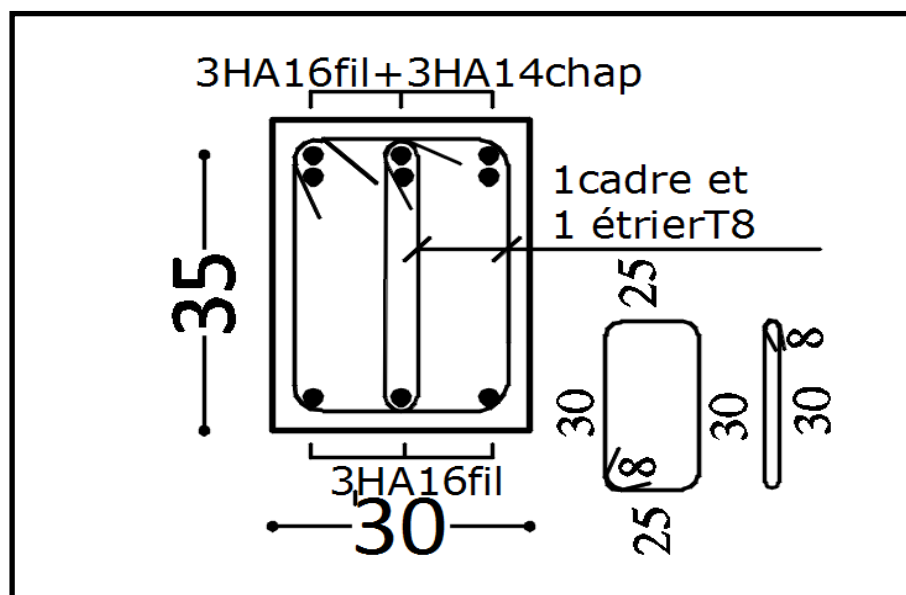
Ferrailage sur appuis d'une poutre principale
